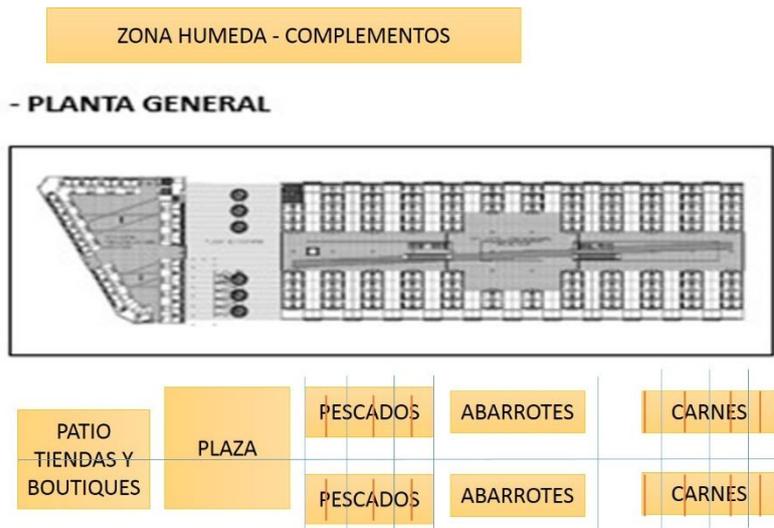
Caso análogo n° 2 Primera planta Circulación.
